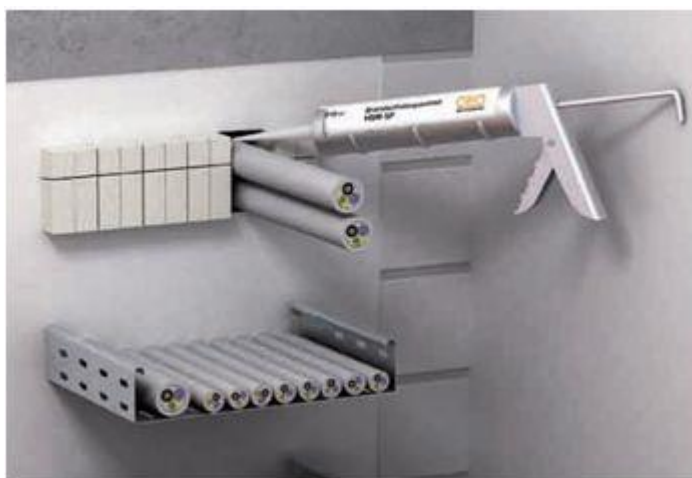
Aplicação da proteção passiva na passagem de cabos em um SFV.
